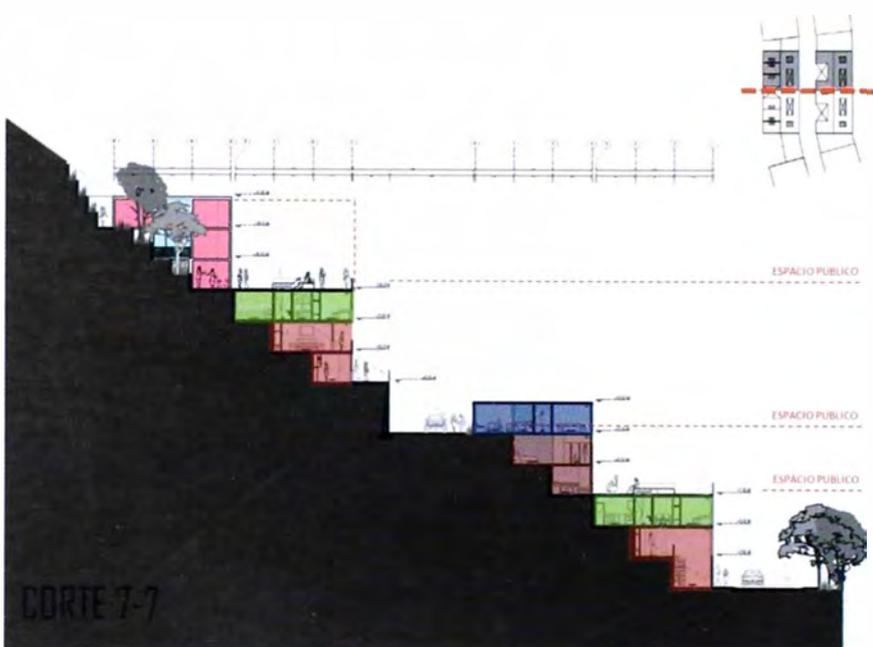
Corte de proyecto vivienda multifamiliar en ladera.
